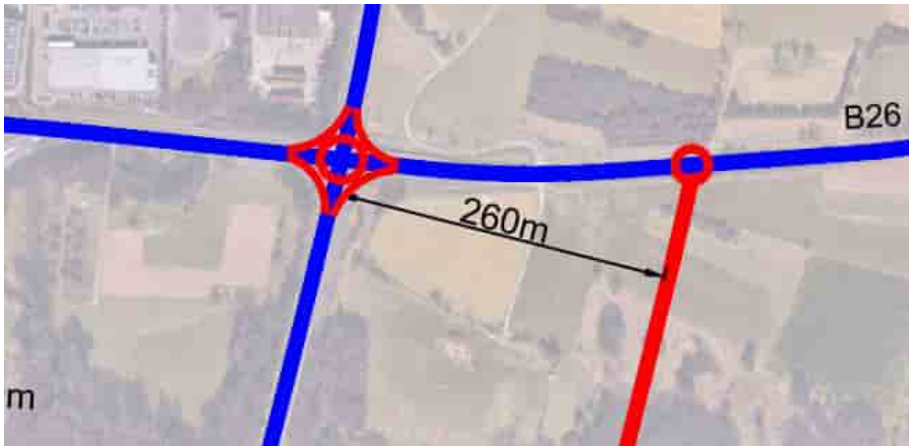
K1 - Stachusknotten als Kreisverkehr mit vier Bypässen – Planfall 6a
